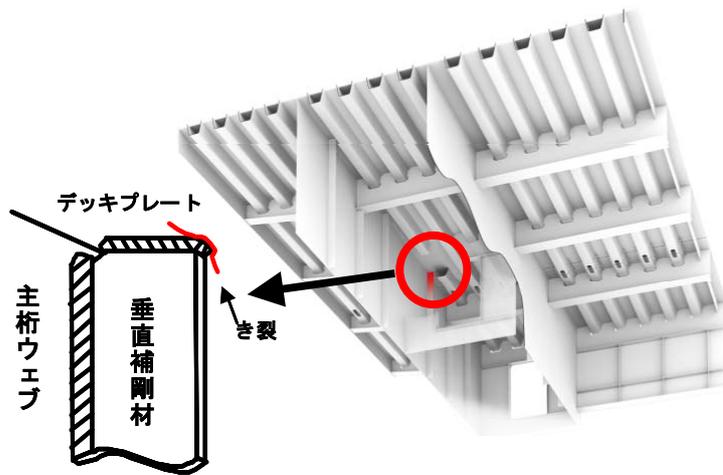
垂直補剛材とデッキプレートの溶接部のき裂
